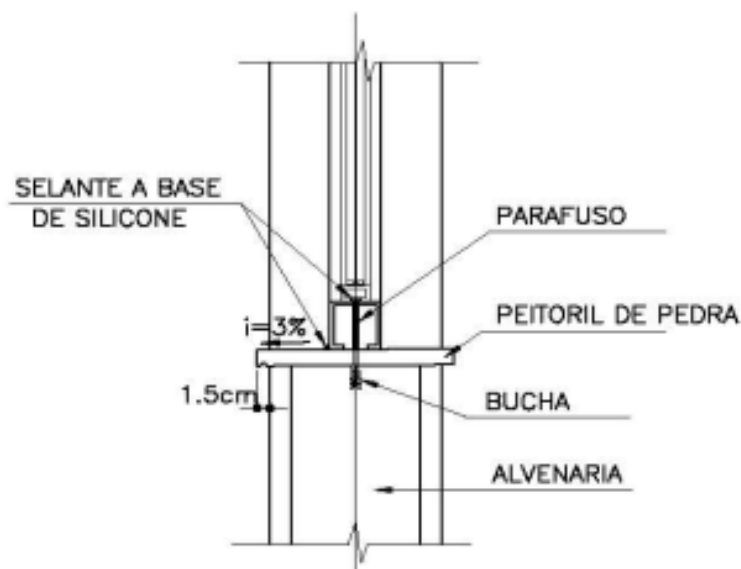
Corte Esquemático Peitoril para janelas instaladas no eixo da alvenaria. (Fonte: SUDECAP-MG)
